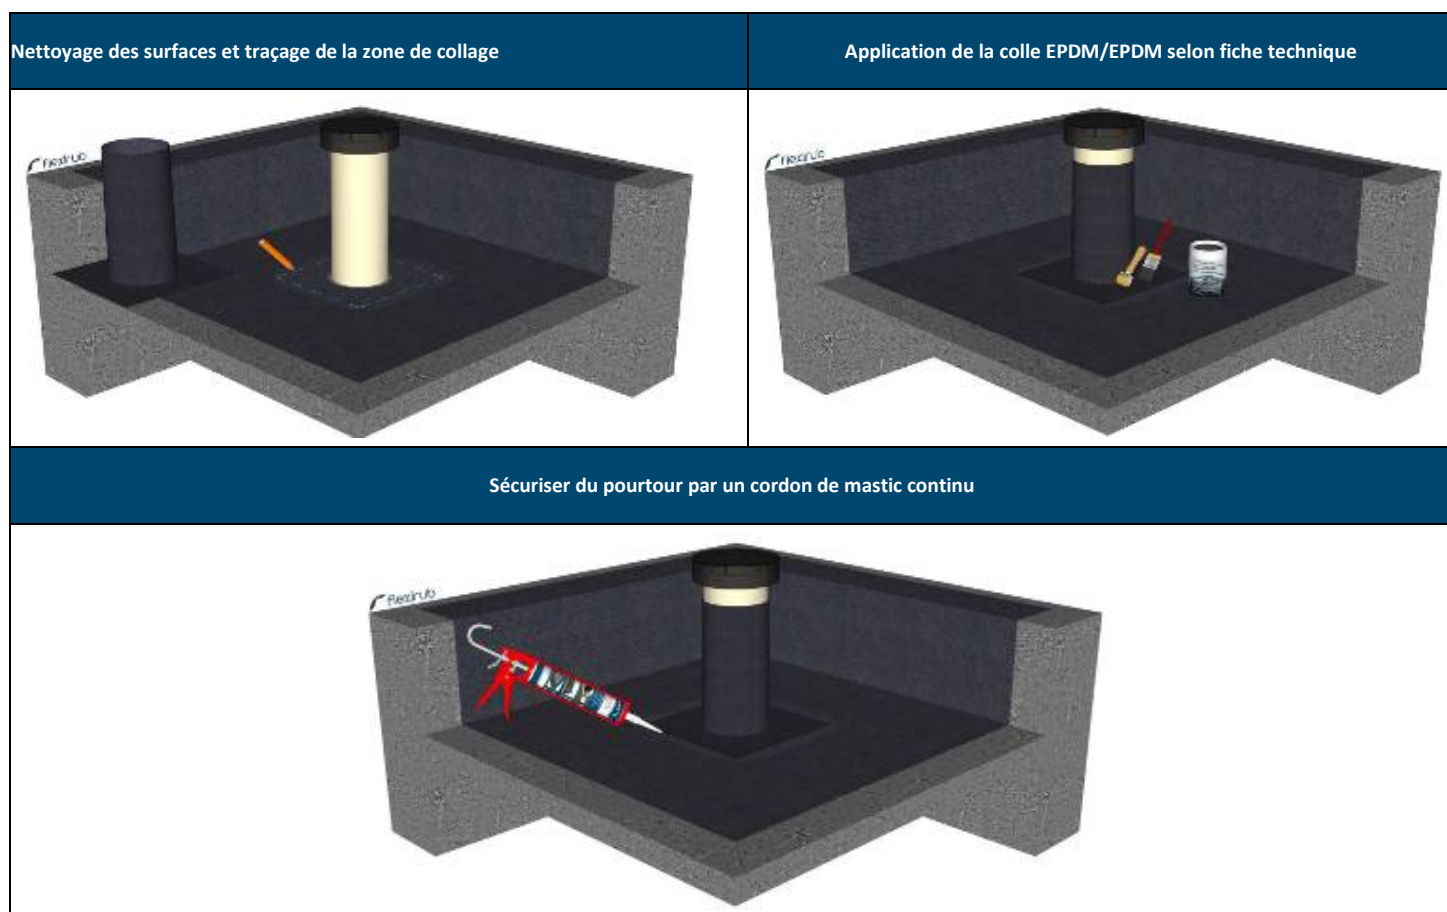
Illustration d'une collerette préfabriquée et collée sur chantier
